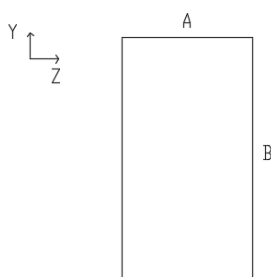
Dimensões em planta das fundações e respetivos eixos
